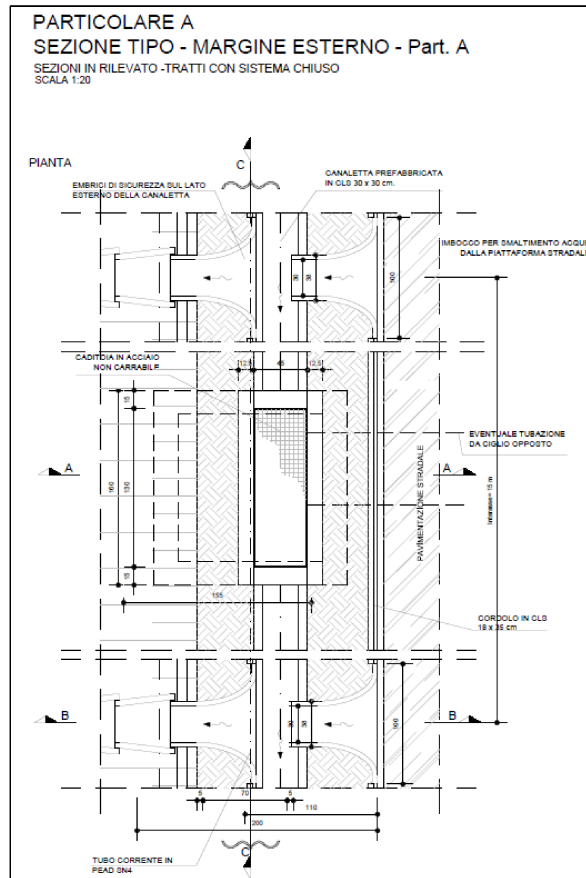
Particolare del sistema di raccolta di tipo chiuso – Vista in pianta
